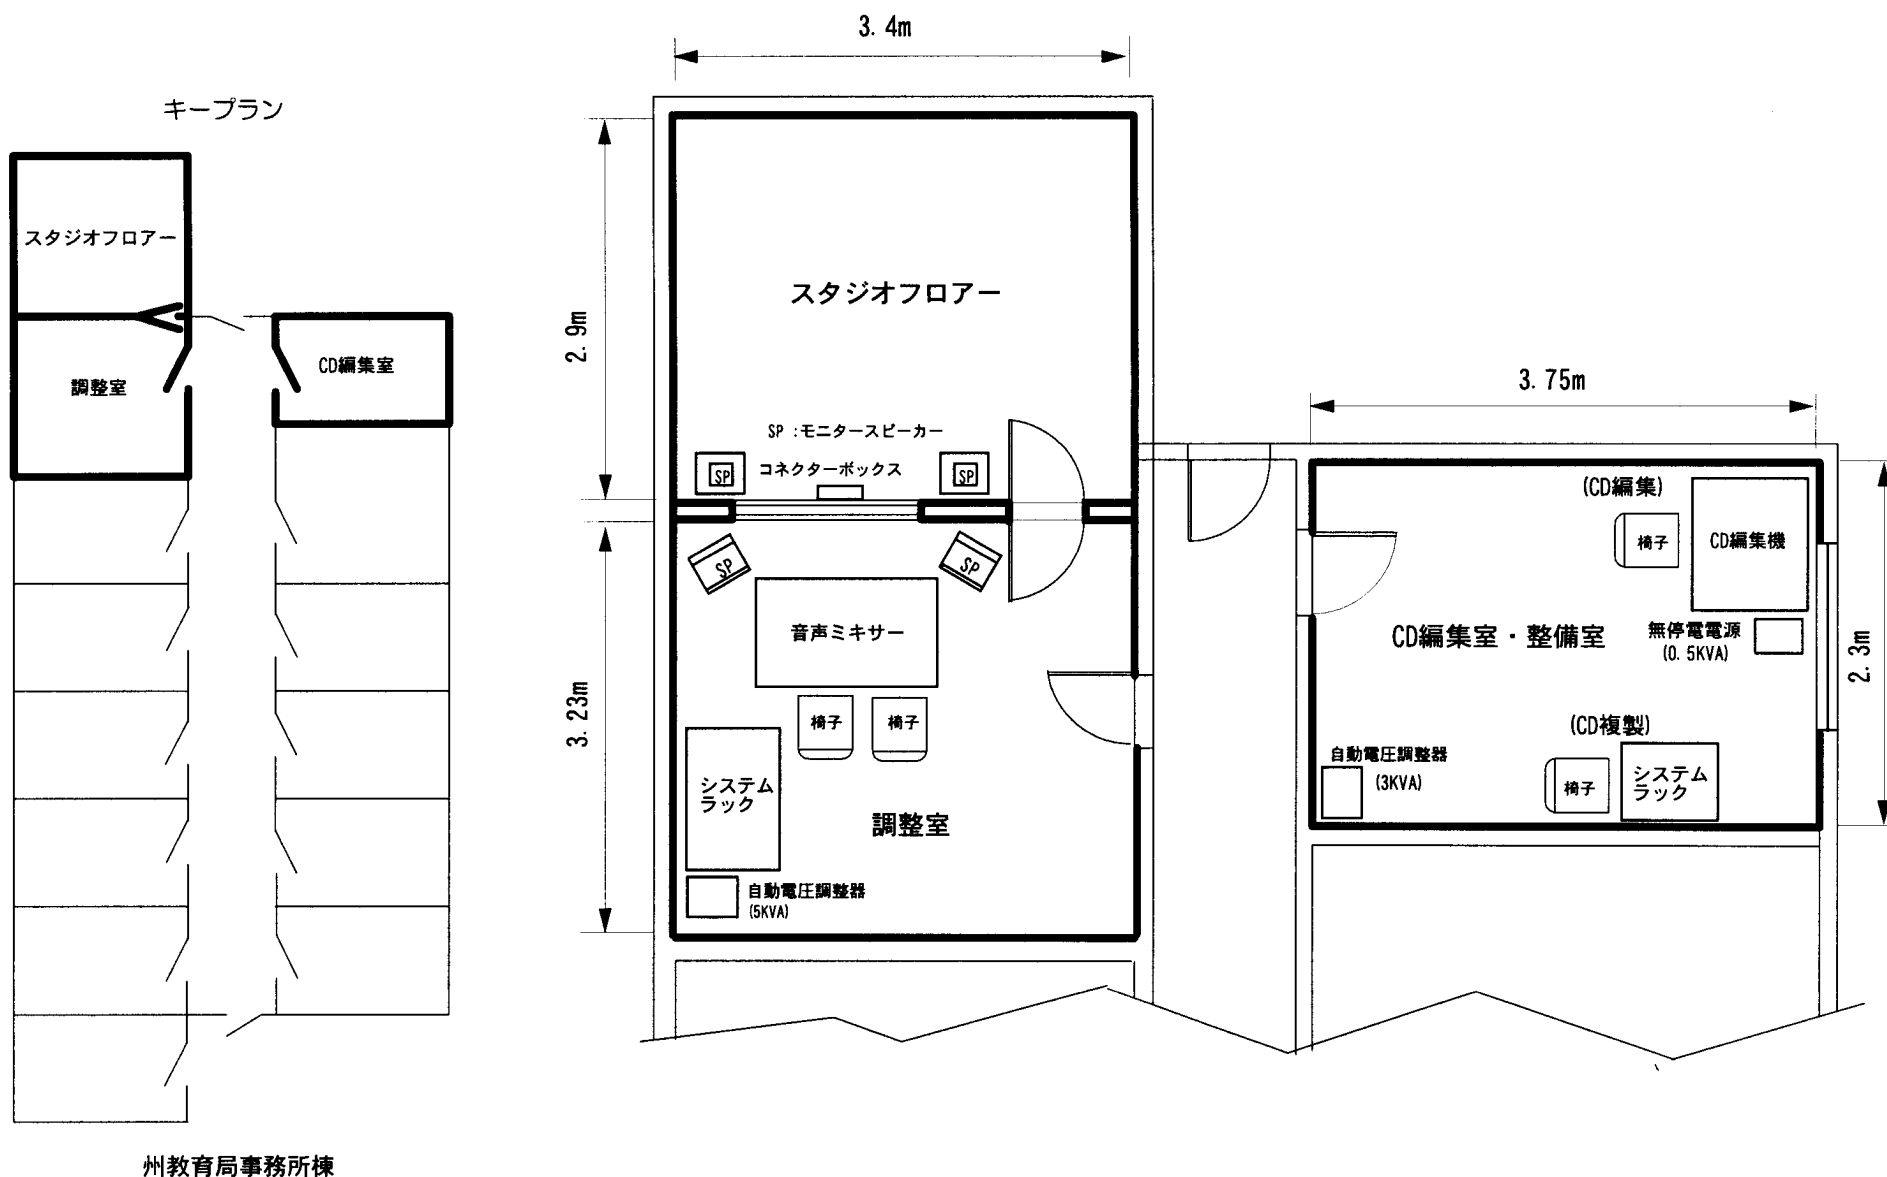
ミザンテフェリ ラジオスタジオ機器配置図
